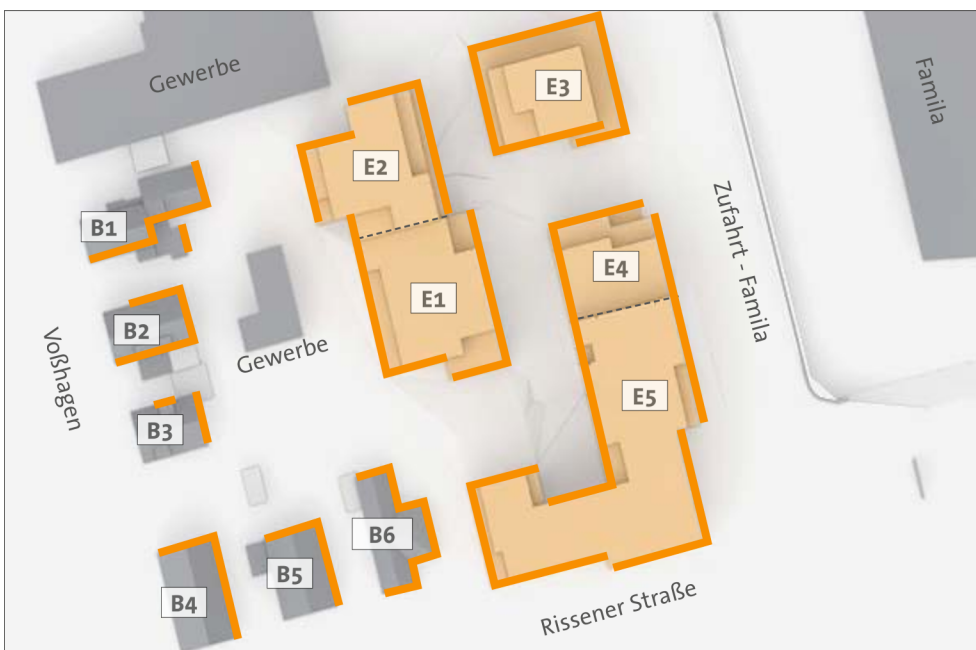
Zu untersuchende Fassaden und Gebäudenummerierung
